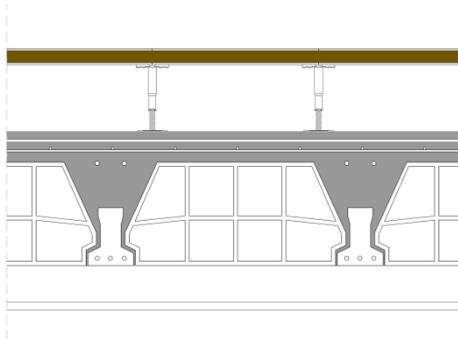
Forjado con suelo técnico. 2014. AutoCAD.
